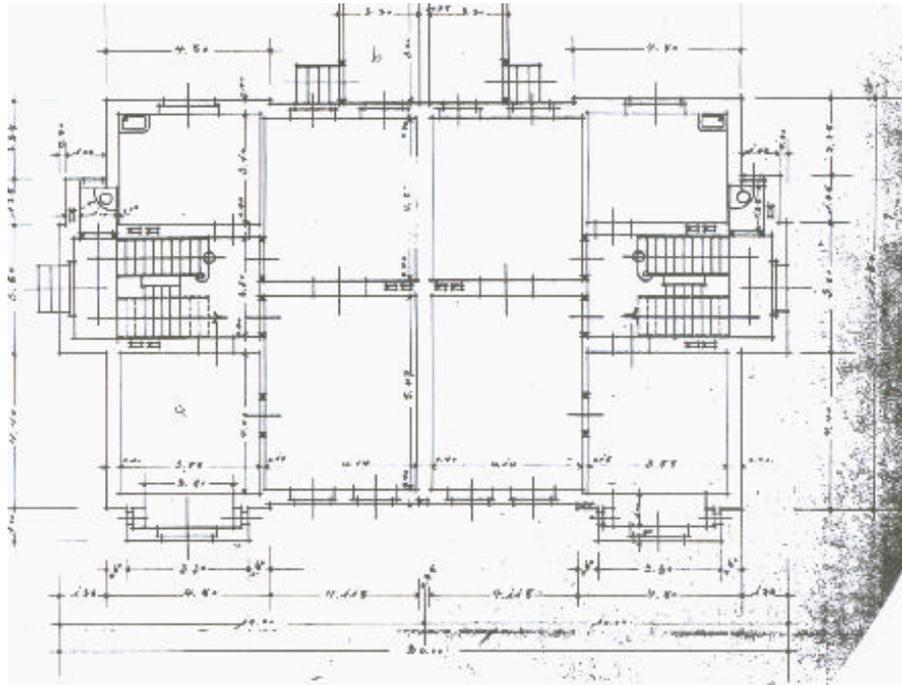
Grundriß Erdgeschoß Jaegerstraße 3/5
